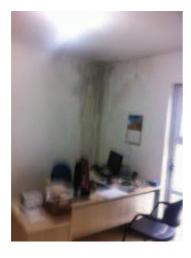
Vista do quarto 1, onde trabalha o locatário. Atenção para a sujidade ao fundo, fruto de vazamento na laje de cobertura.
